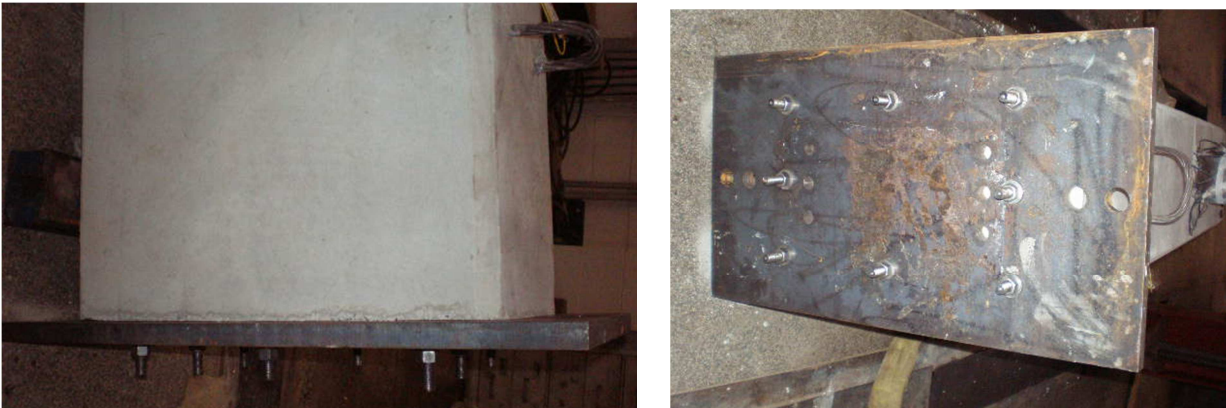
Posicionamento da chapa de aço na face inferior do pilar para fixação na laje de reação.
